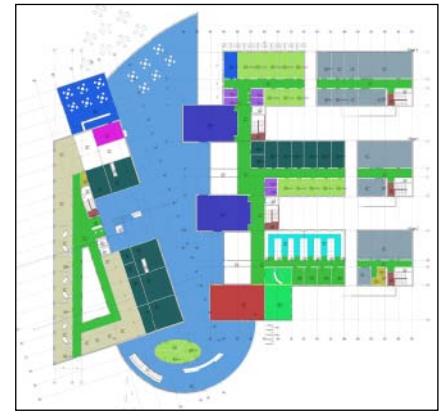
+9: Aus einem BIM-Modell kann jederzeit Planmaterial z.B. Grundrisse, Schnitte, Ansichten, etc. entsprechend der gewünschten Detailtiefe für unterschiedliche Zwecke während der Planung und im Betrieb extrahiert werden.
